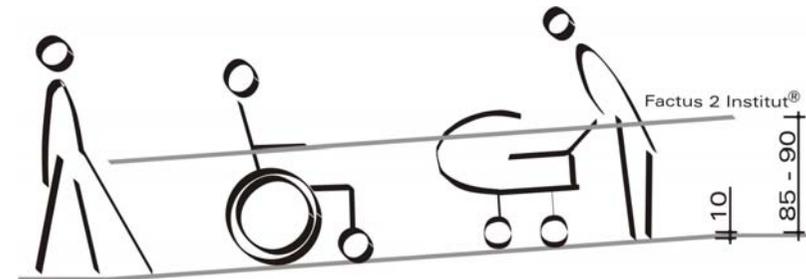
© Factus 2 Institut® Schema Rampenlängsschnitt
